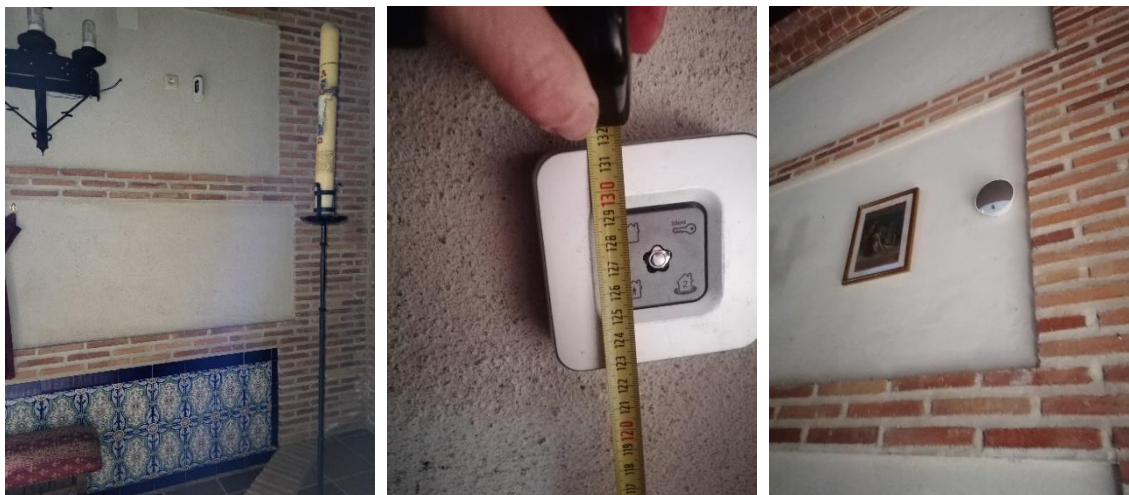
Cámara de vigilancia, panel de control y sirena. Sistema de alarma elevado
